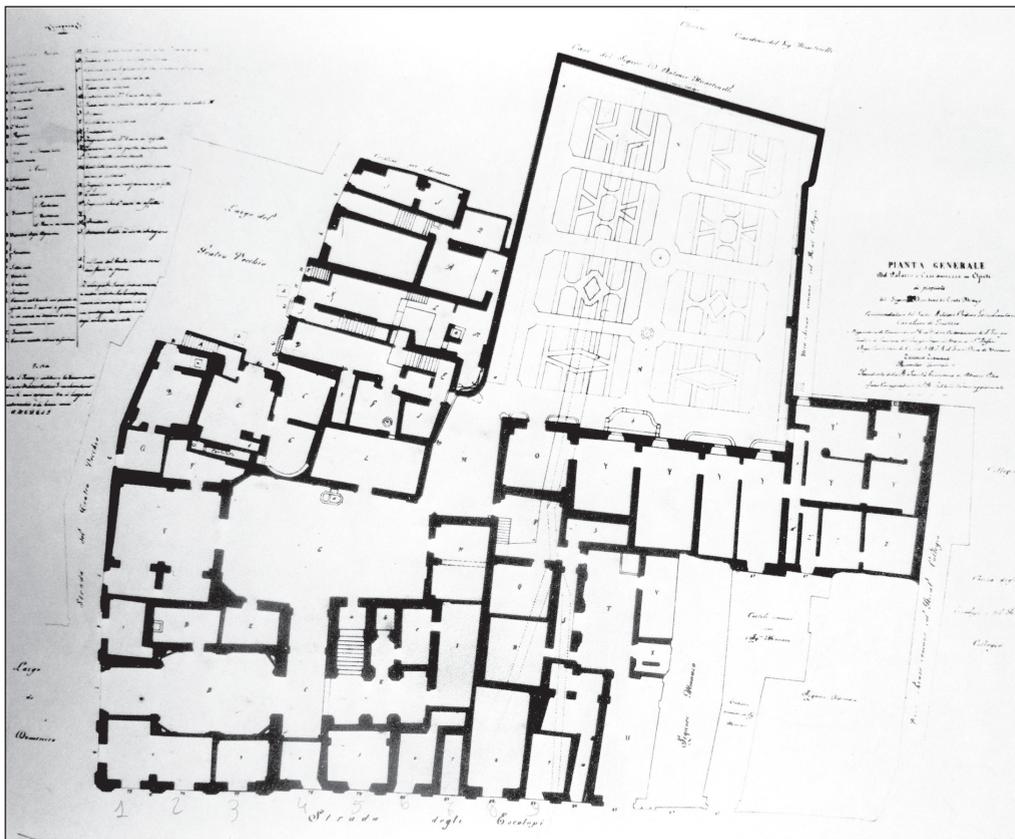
Planimetria del Palazzo de' Mayo del 1836.
